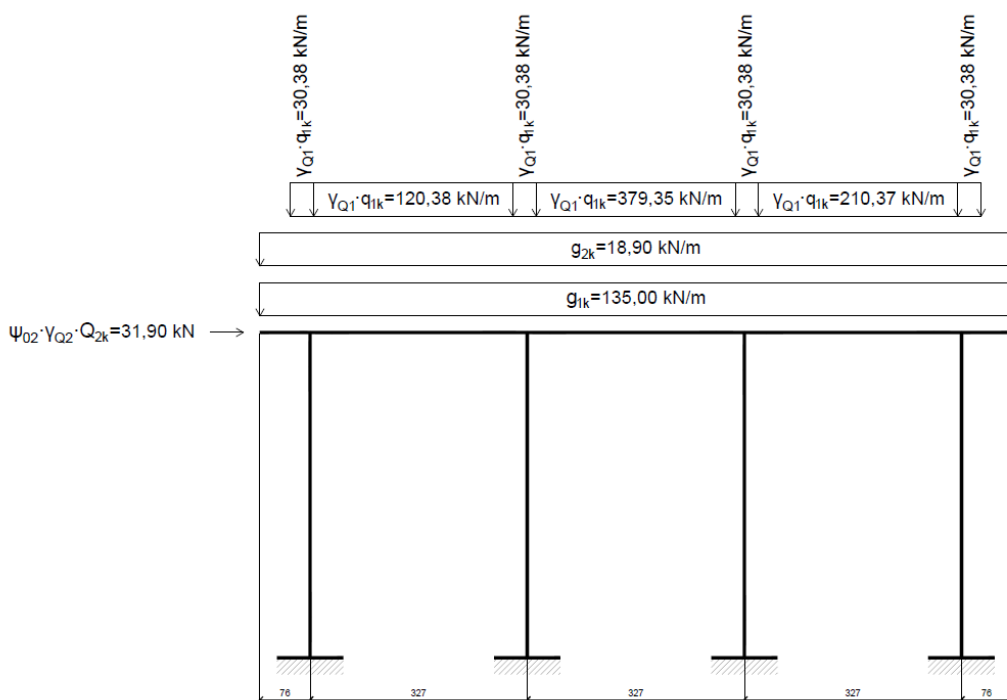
Schema statico della pila della US2 allo stato di progetto in combinazione SLU1.
